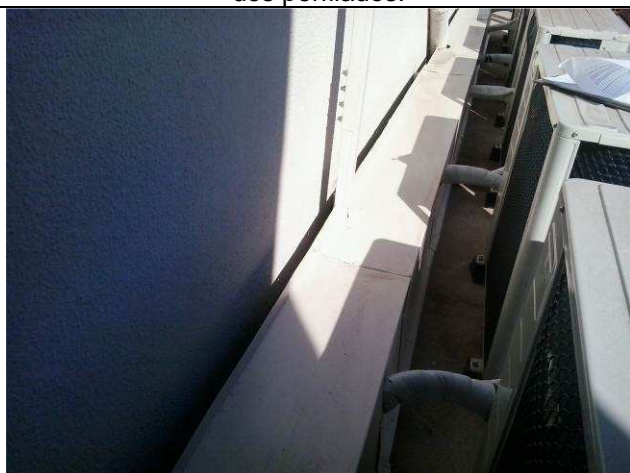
C: Acabamento tipo calha para a prumada horizontal externa de tubulações.
